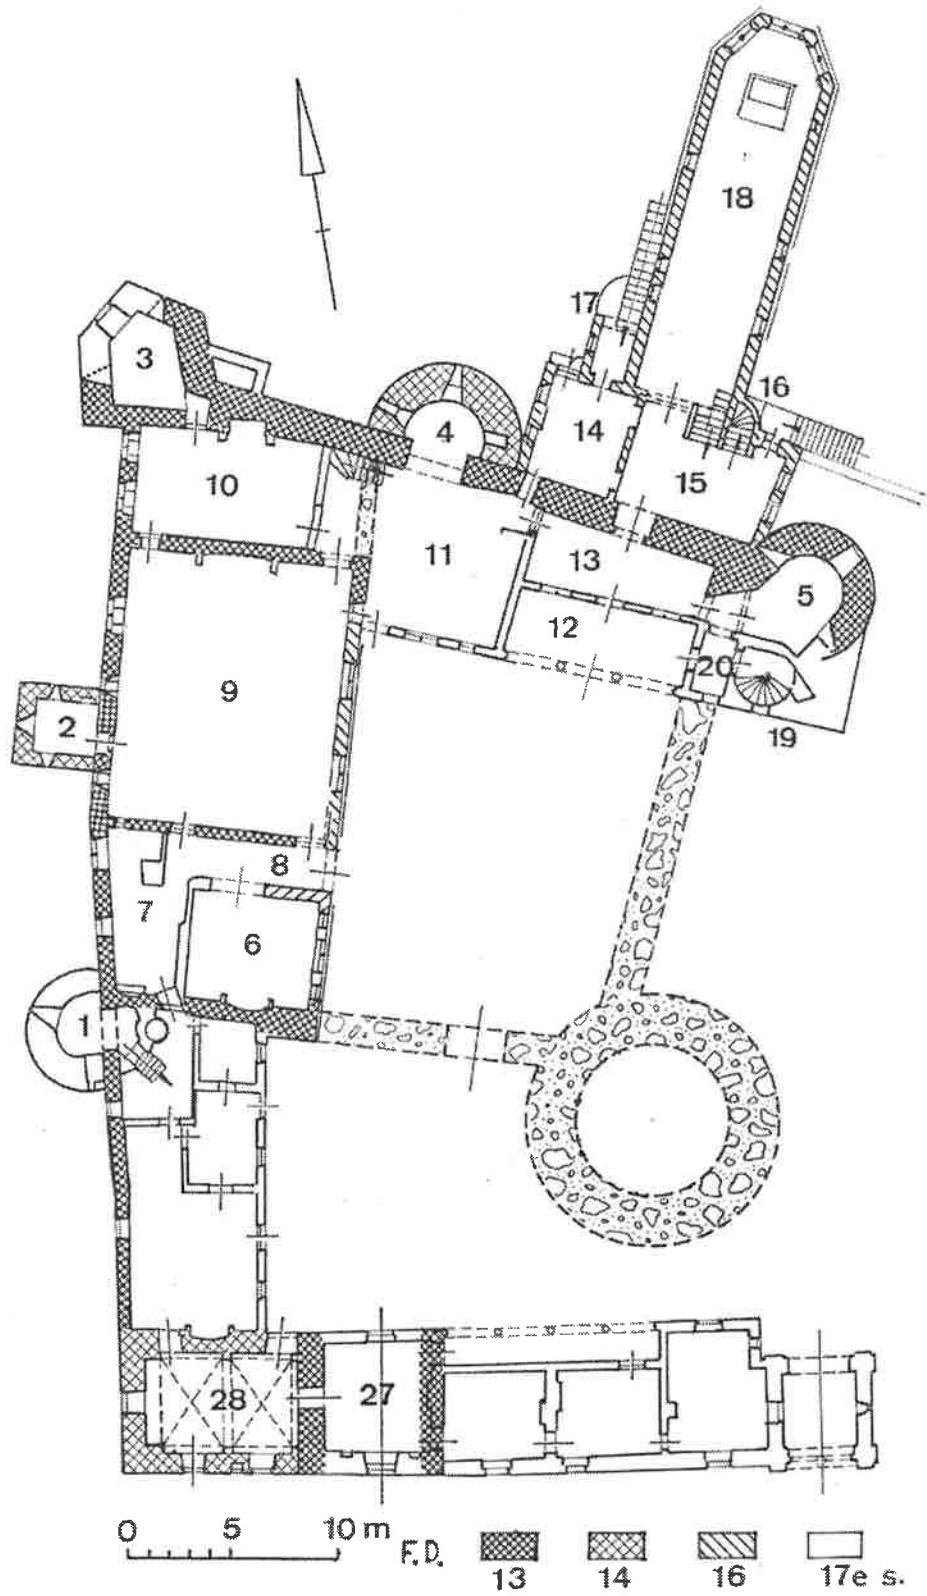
Ecaussinnes-Lalaing, plan chronologique du rez-de-chaussée du château
